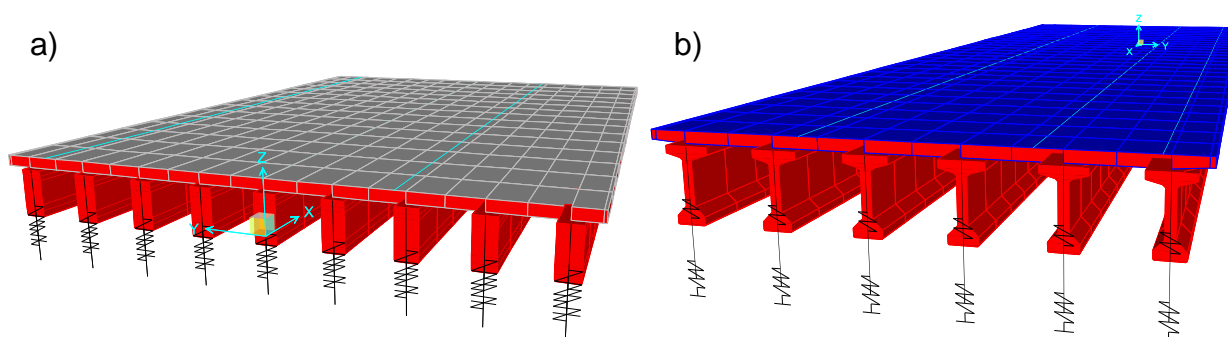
Modelação estrutural dos tabuleiros. a) Vigas rectangulares, b) Vigas em “I”. Fonte: CSiBridge.
